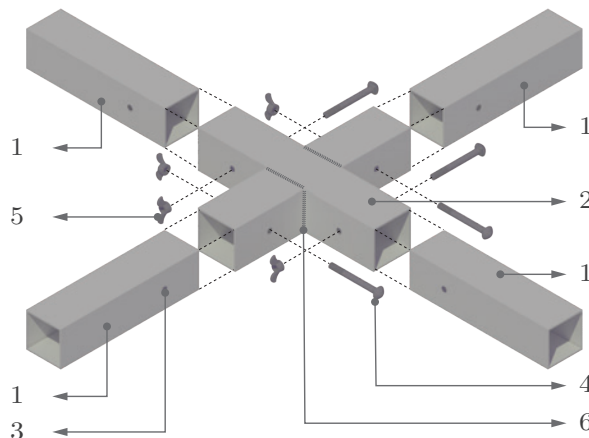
Detalle de la conexión de cubierta plana de 4 vías a 90º del habitáculo Modular Emergency Plant. Fuente y elaboración: Autores.
